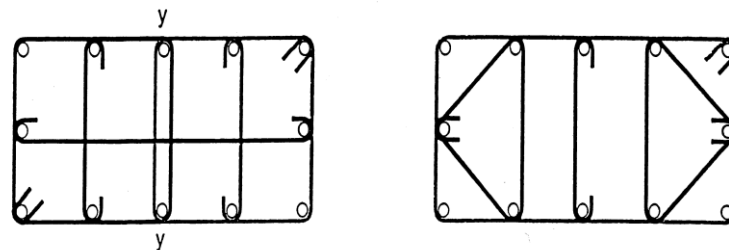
Armatures transversales des poteaux ont des dimensions importantes [7]
